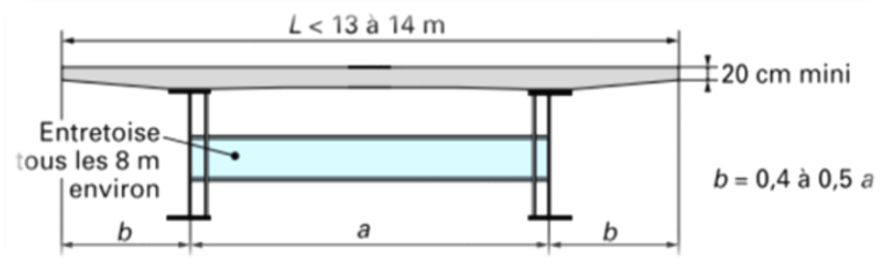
Coupe transversale d'un tablier bipoutre.
